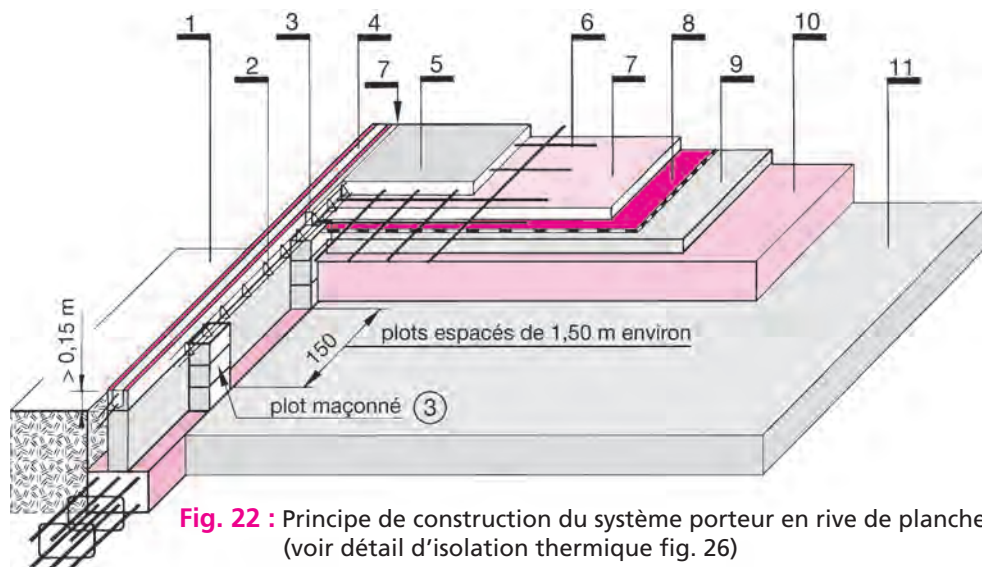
Principe de construction du système porteur en rive de plancher (voir détail d'isolation thermique fig. 26)
